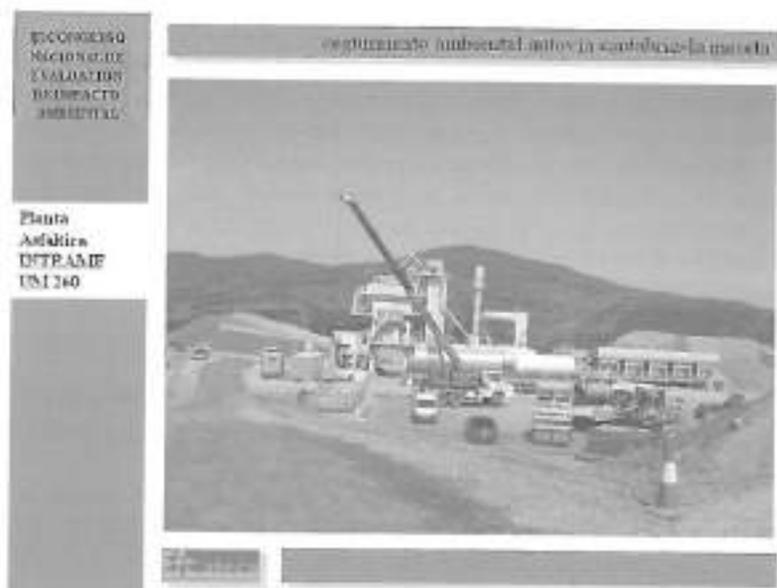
Ubicación de Planta Asfáltica fuera de zonas excluidas.
